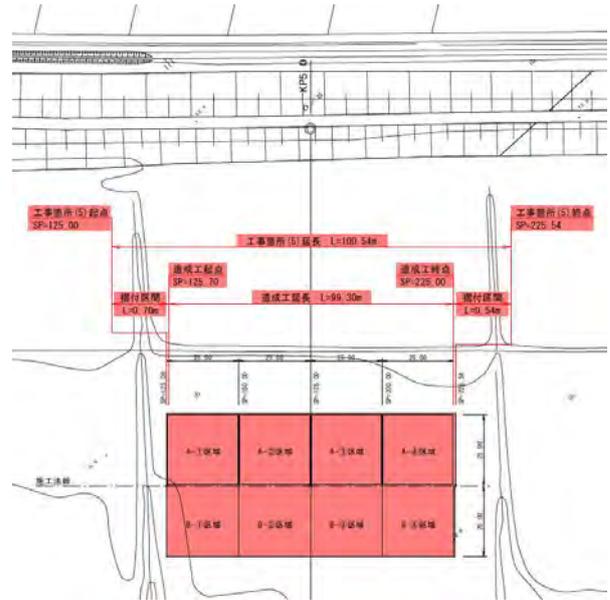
試験地平面図(夕張川右岸 KP5.0 付近)
